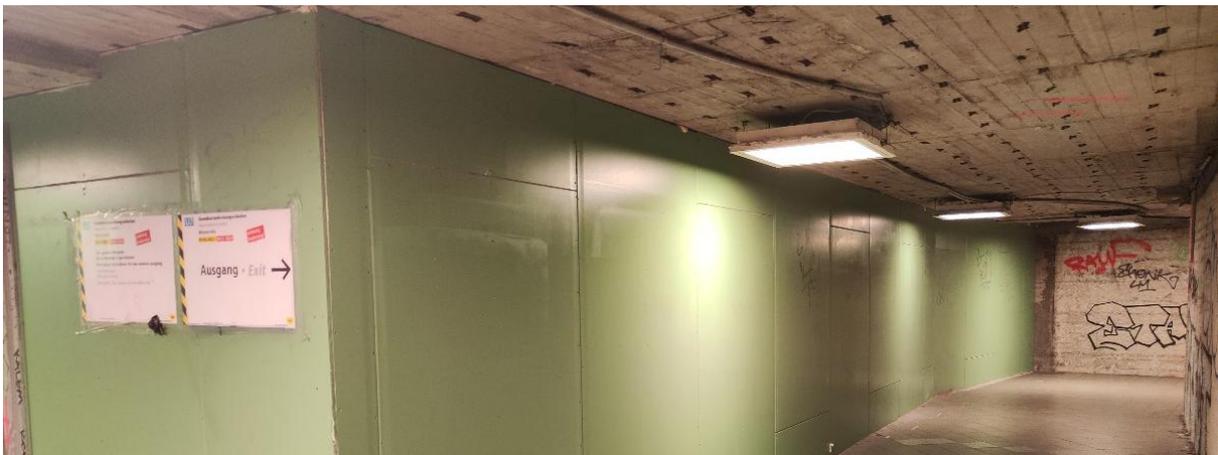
Baustelle im Eingang zum U-Bahnhof Blissestraße
